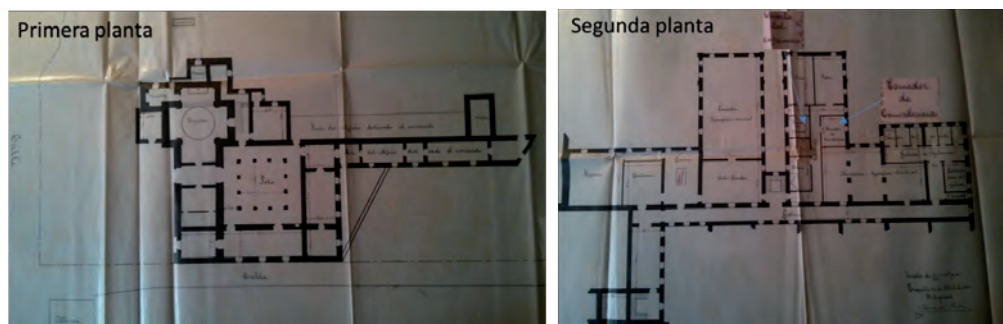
Plano de la primera y segunda planta del edificio que albergaría al Hospital Municipal (Legajo 1086-13).
